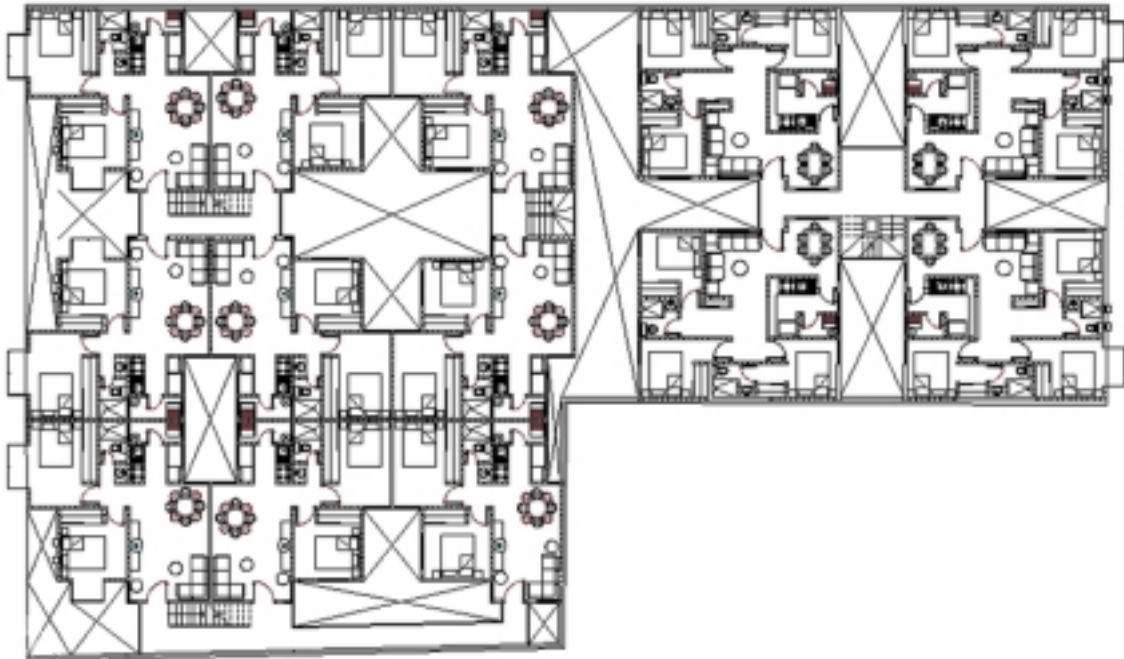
Planta arquitectónica Lázaro cárdenas
